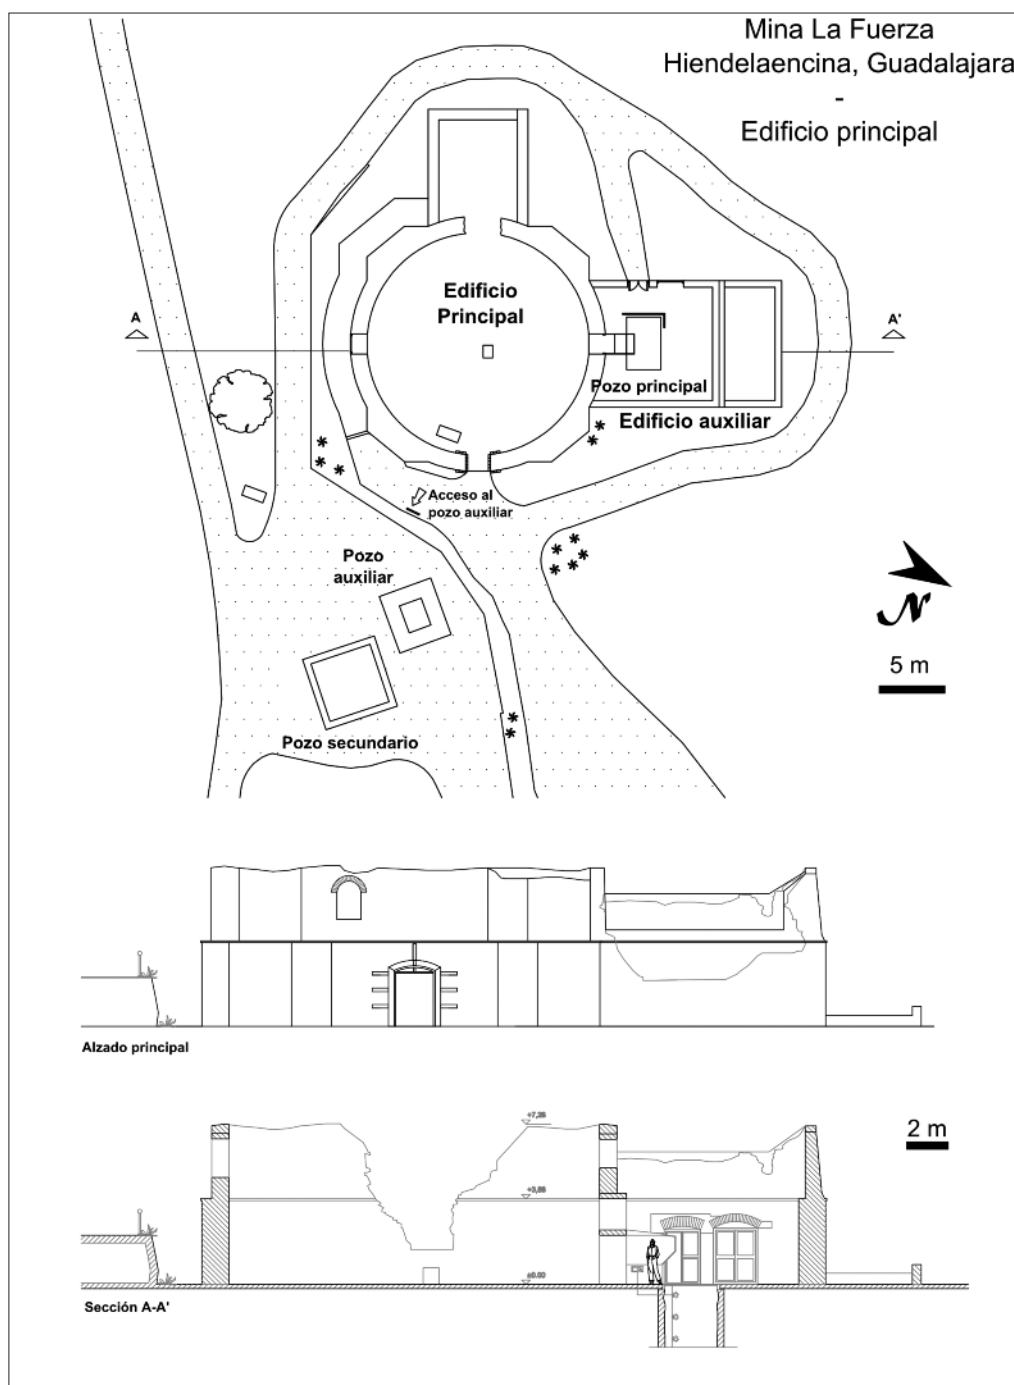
Planta, alzado y sección de la mina La Fuerza, mostrando los resultados de la intervención propuesta para afianzar la estructura y permitir observar el pozo minero principal.
